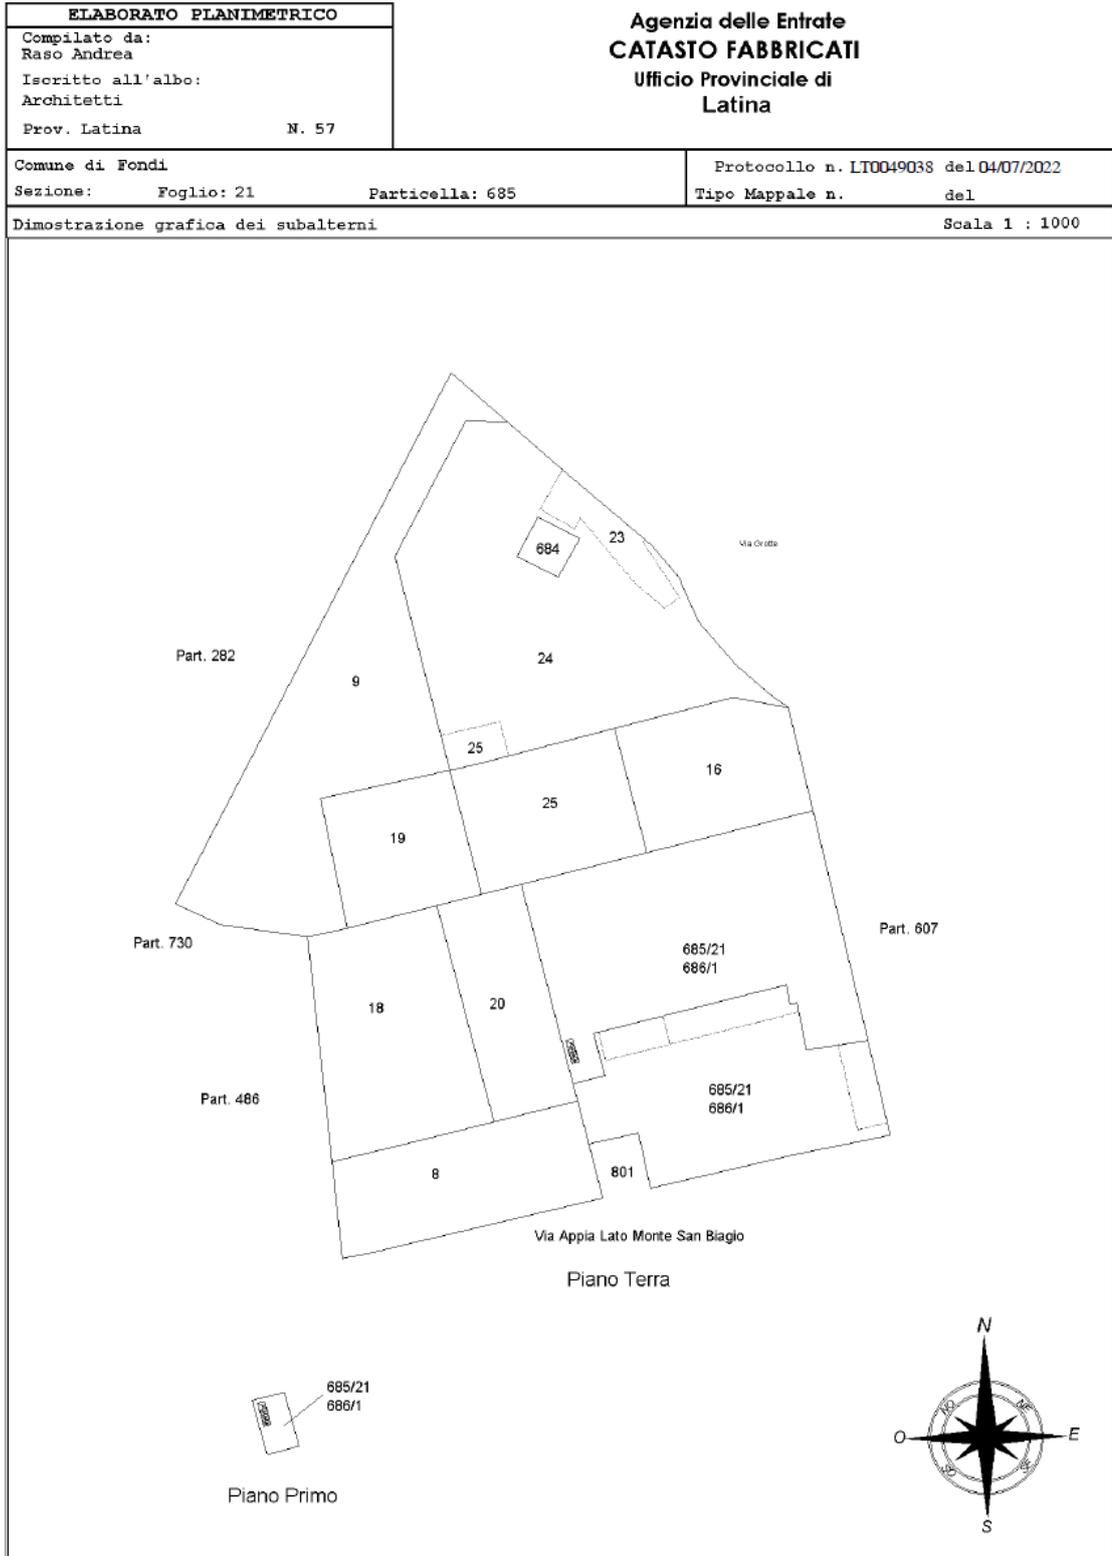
Elaborato planimetrico particella n.685 aggiornato al 4/07/2022
